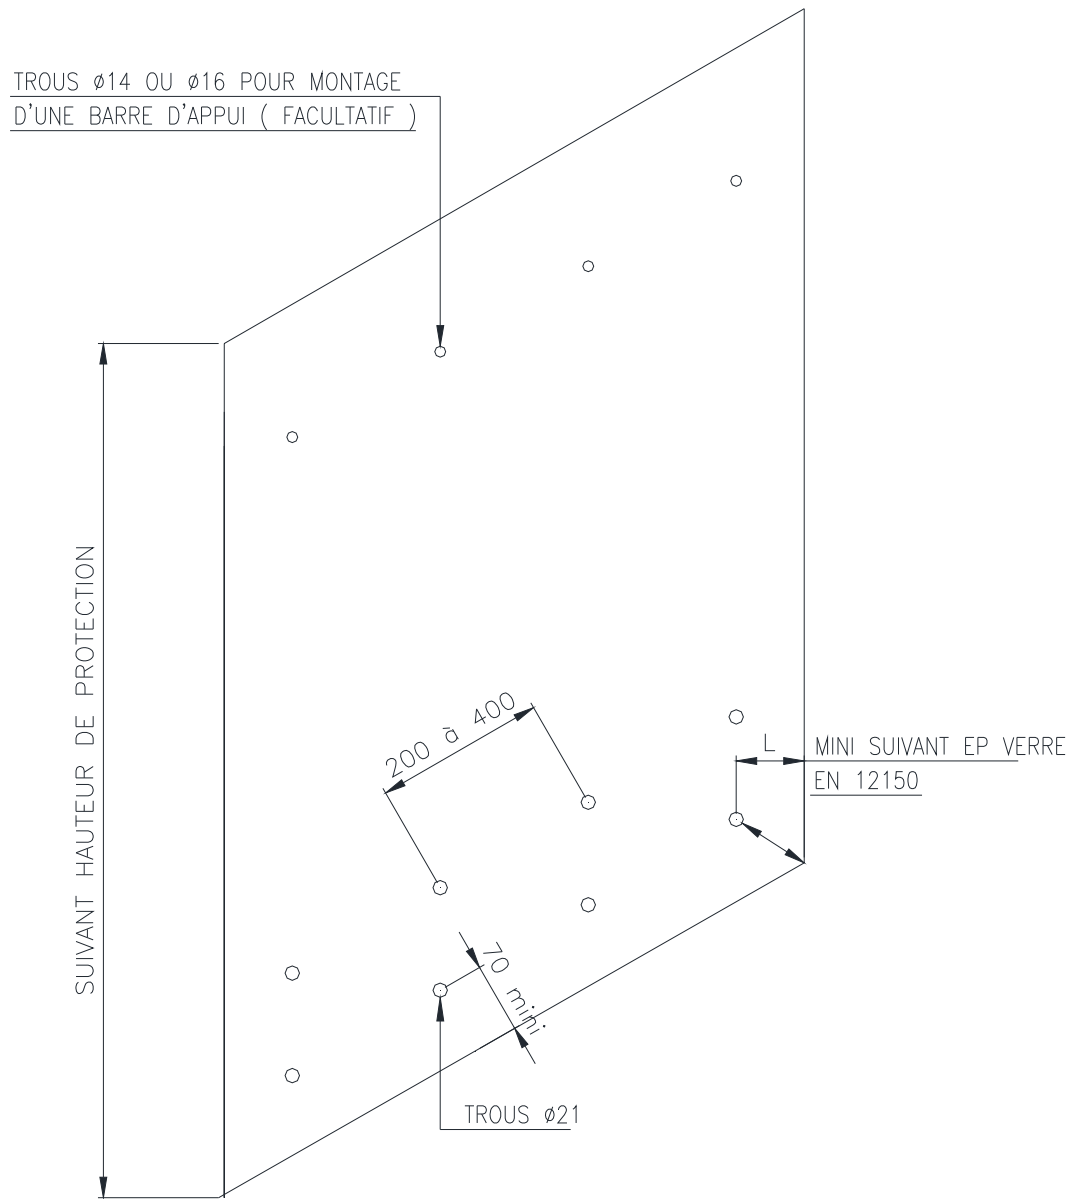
Vitrage plan Structaflex pour Balustrade P XS _ Cas d'un rampant
